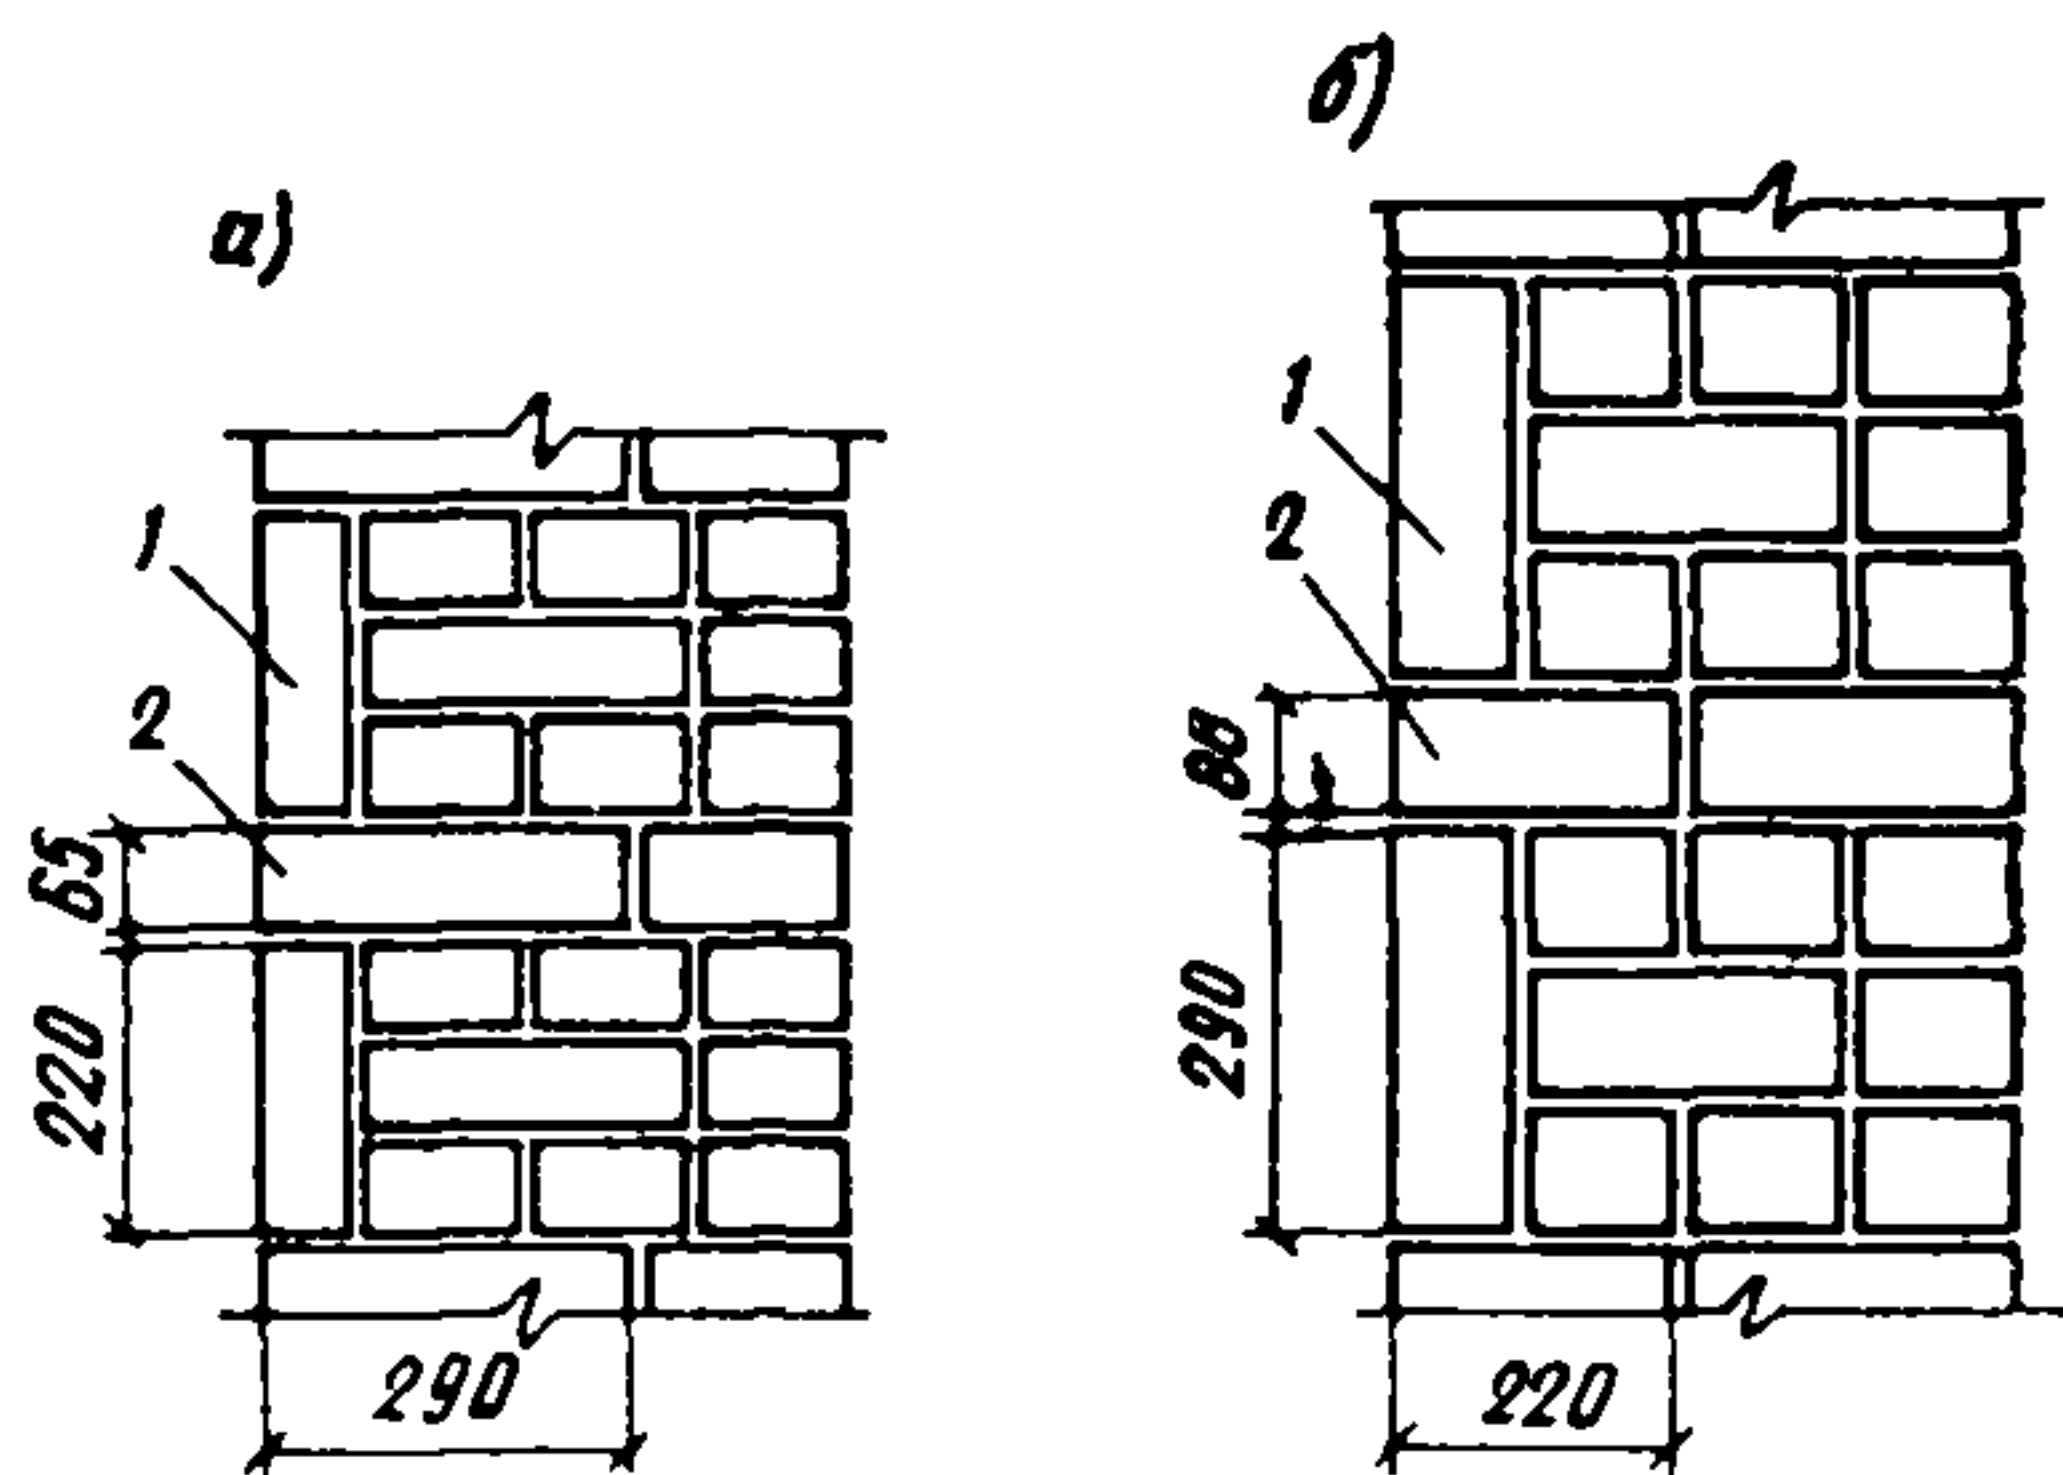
Кладка типа XIIIa из кирпича, облицованная плоскими плитами с прокладными рядами из тех же плит
